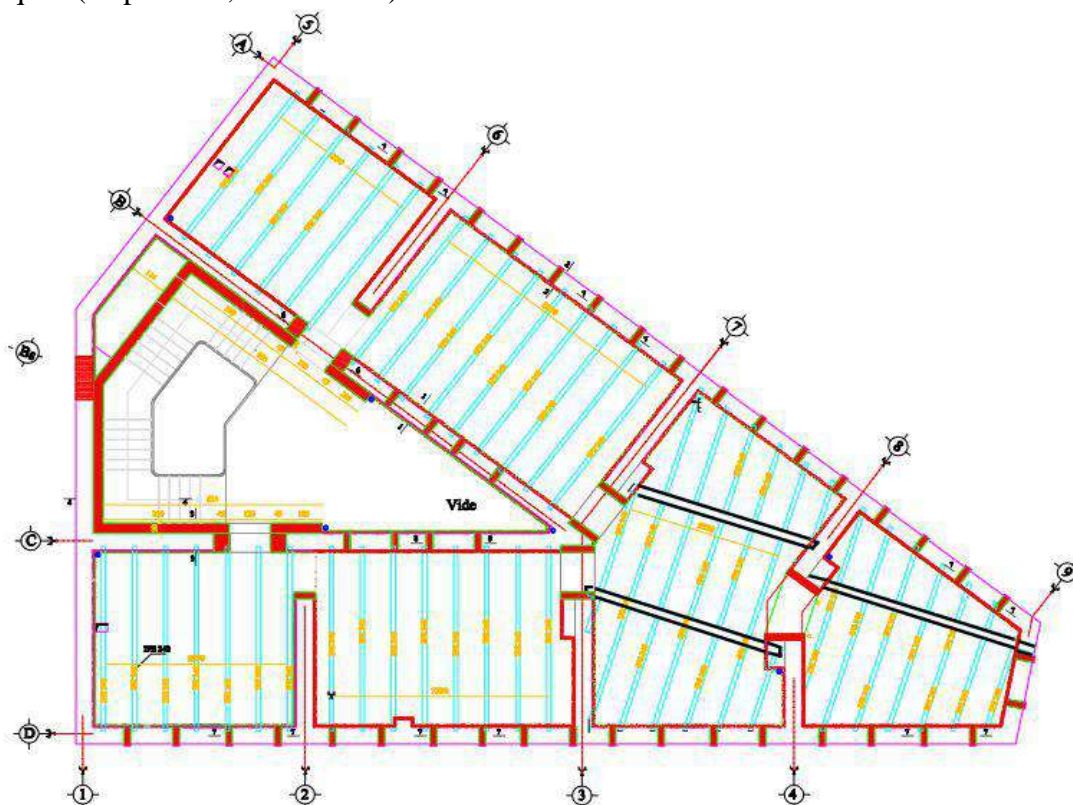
2 : Disposition en plan des solives métalliques, source : dossier graphique béton et béton armé réalisée par l'ingénieur du BET (IPE240 en bleu, HEB260 en noire)
